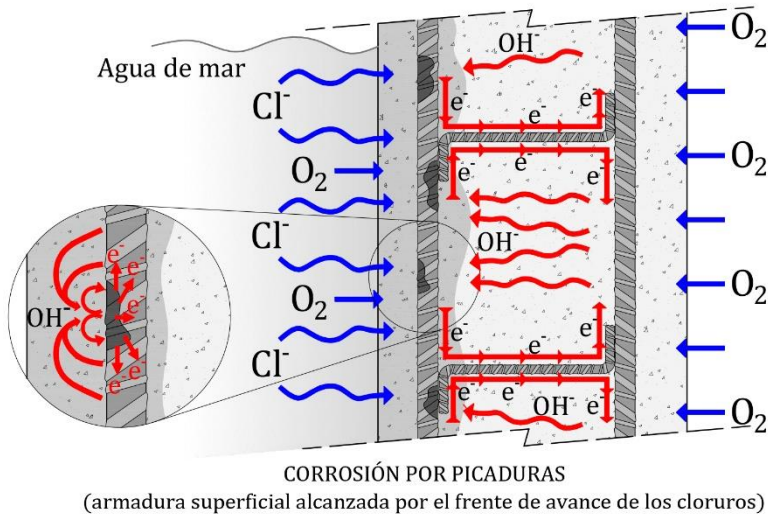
21- Muro de hormigón armado con daños por picaduras. Elaboración propia
